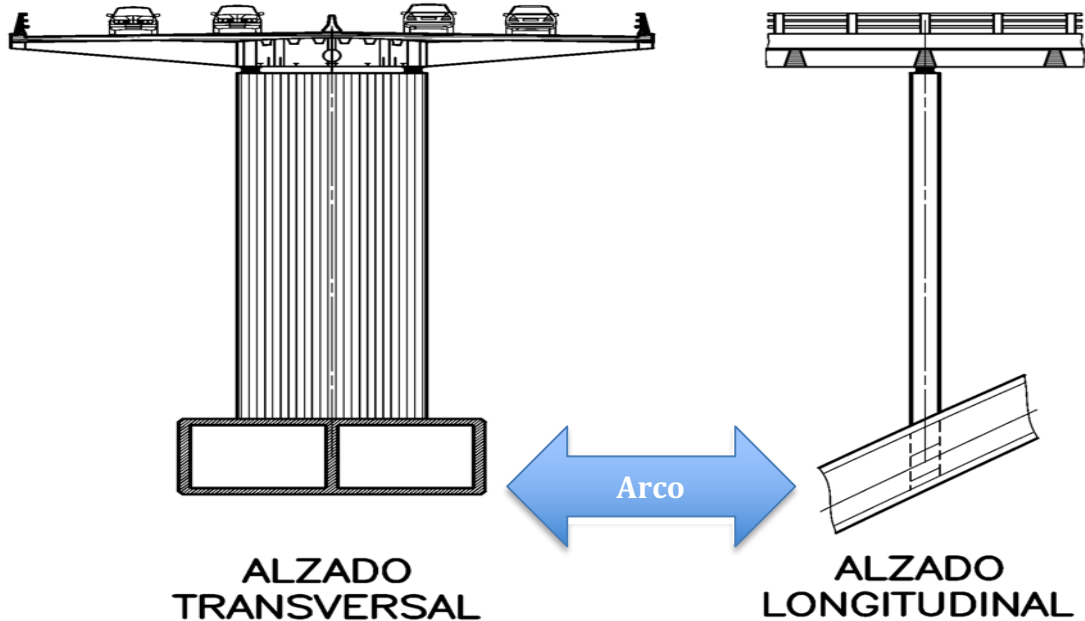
Distintas vistas de alzado (transversal y longitudinal). [13]
